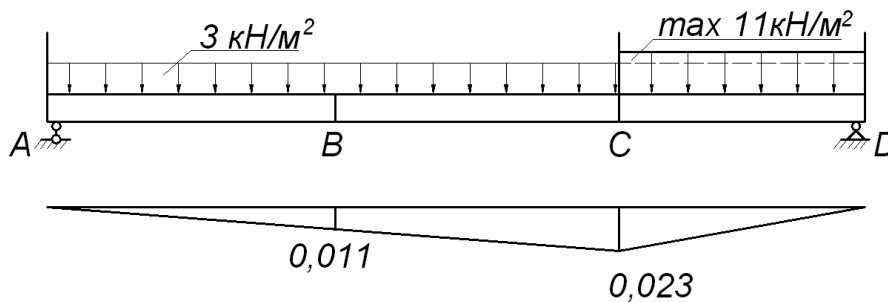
Характер деформирования фрагмента перекрытия при нагружении по схеме 1.
